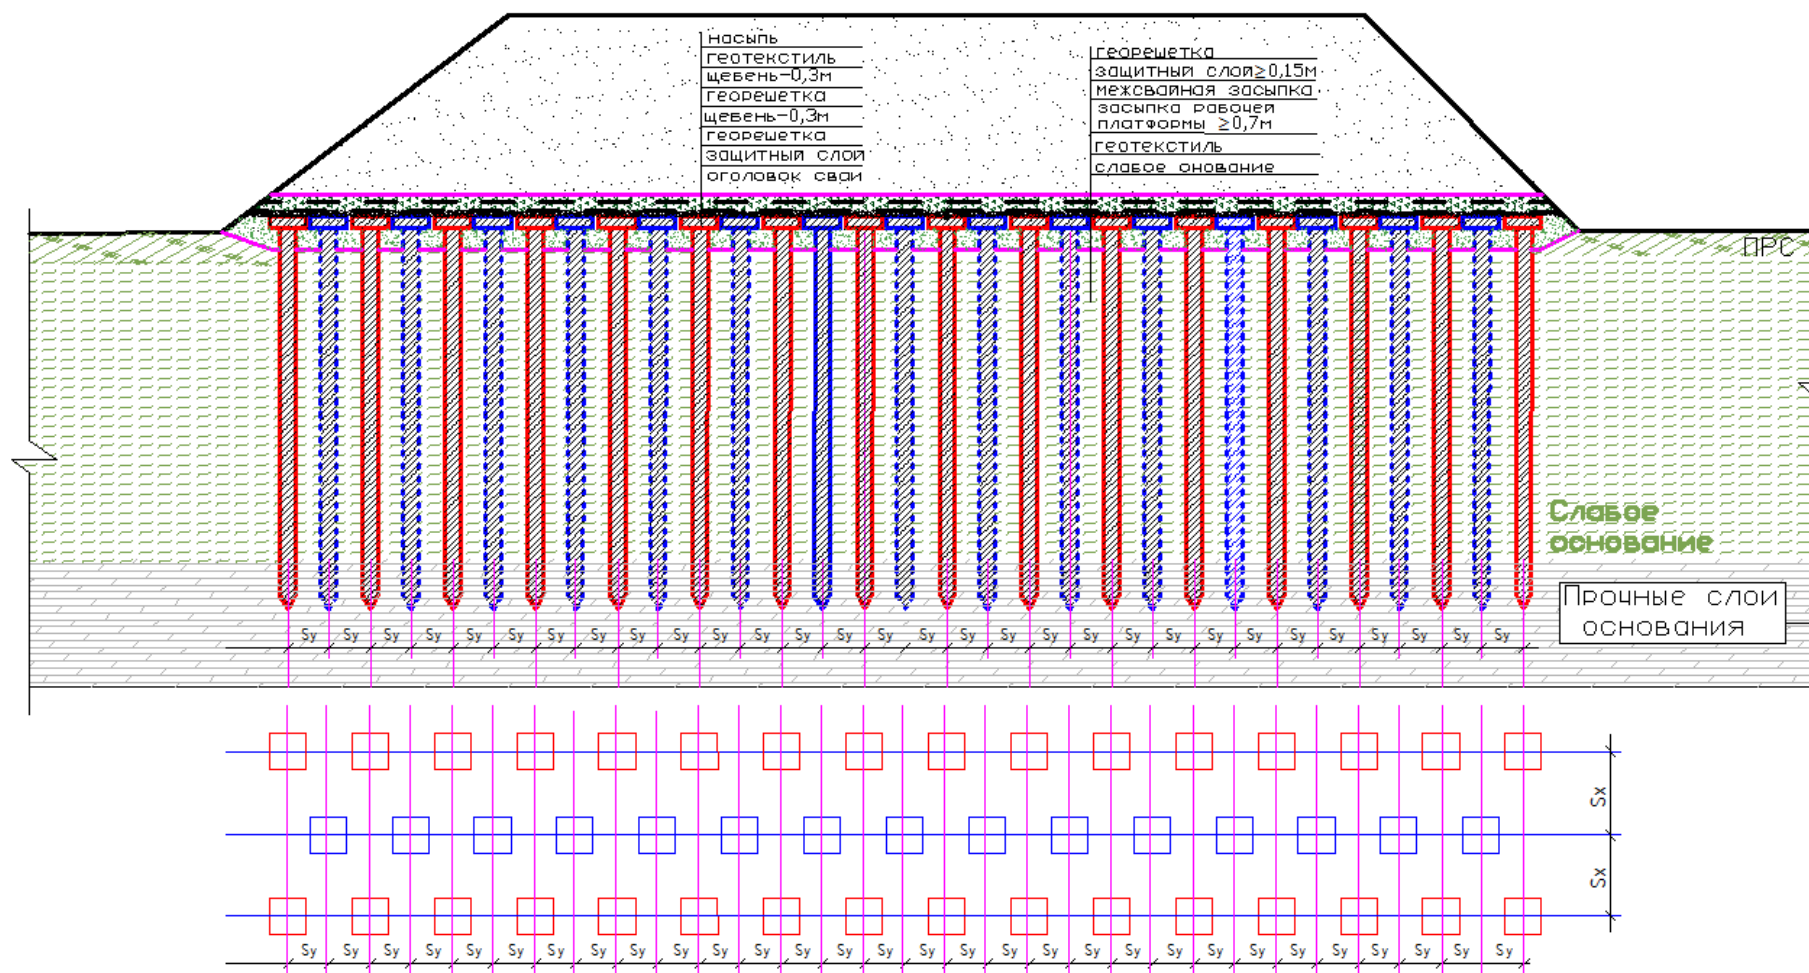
Гибкий ростверк из двух слоев георешетки со щебнем на железобетонных сваях с оголовками (с размещением свай по треугольной сетке в «шахматном порядке»)
